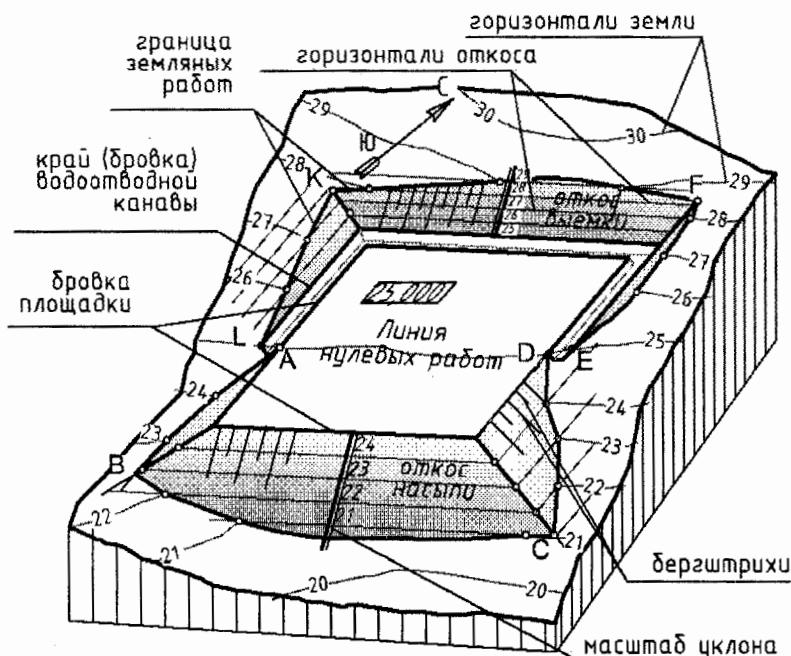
Горизонтальная площадка с примыкающими к ней откосами насыпи и выемки
